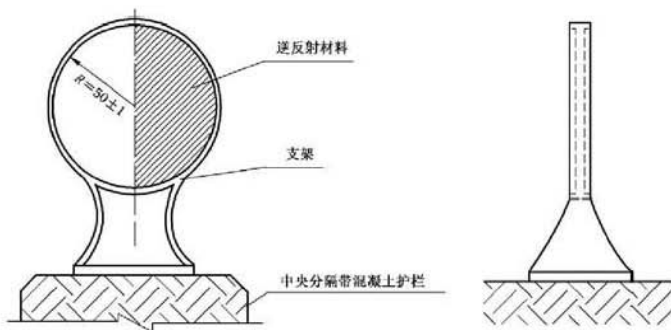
安装于中央分隔带混凝土护栏上的轮廓标结构和安装示意图
